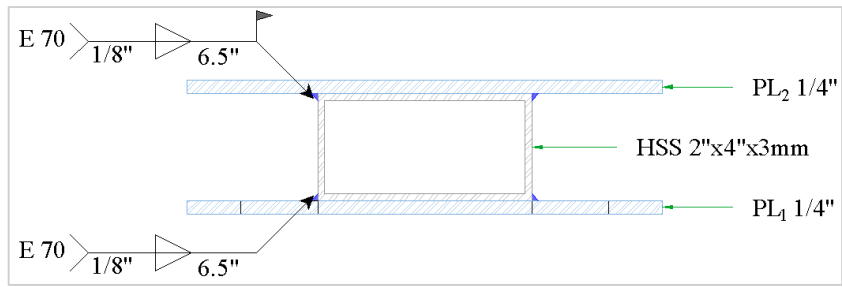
21. Detalle conexión viga - placa PL1 y PL2
